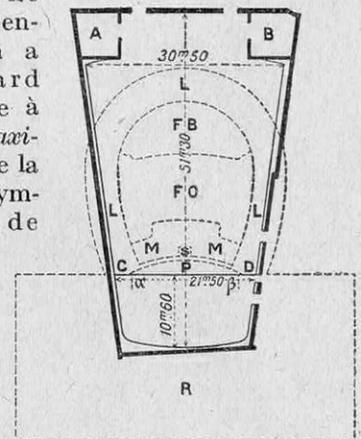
LE PLAN DE LA SALLE PLEYEL
